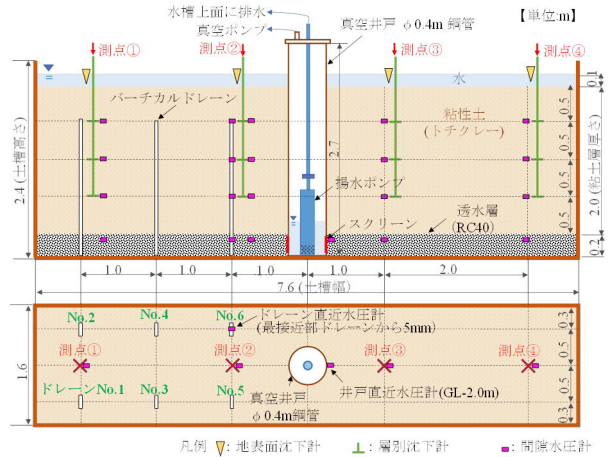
屋外大規模実験土槽断面図(上)・平面図(下)
